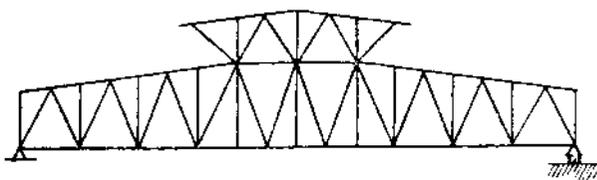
металлическая решетчатая ферма, у которой в средней возвышенной части устроено приспособление для вентиляции перекрытого помещения.
